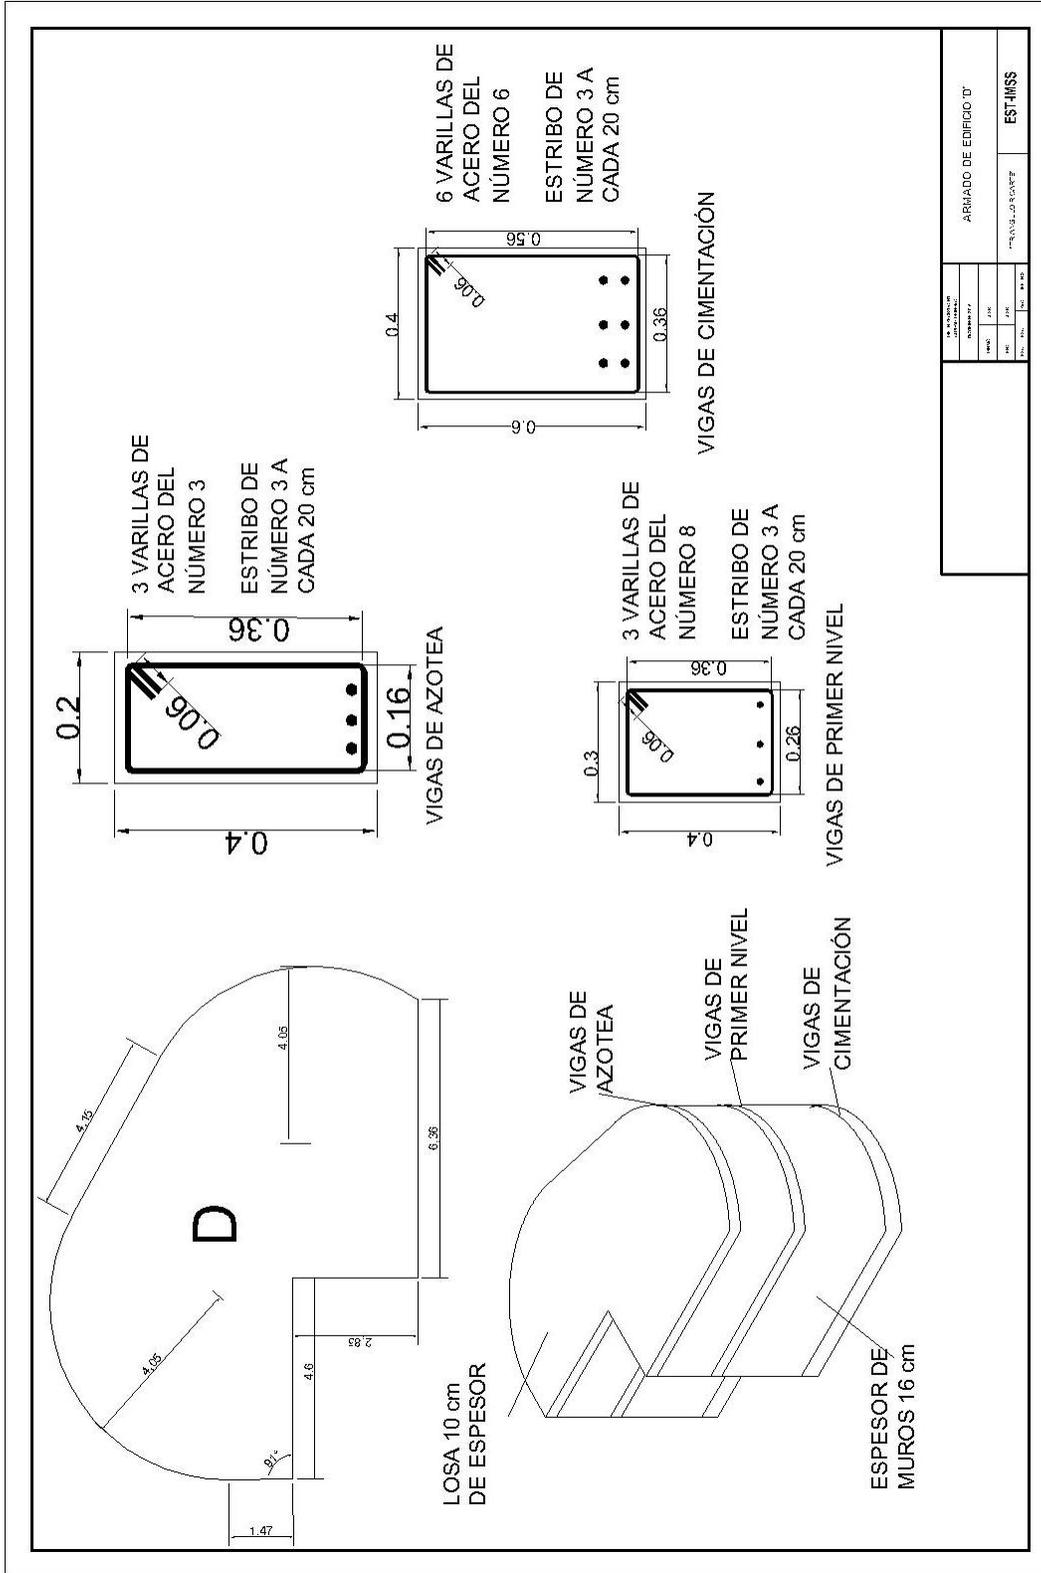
Plano de vigas de edificio "D" (fuente: dibujo hecho por el autor).
